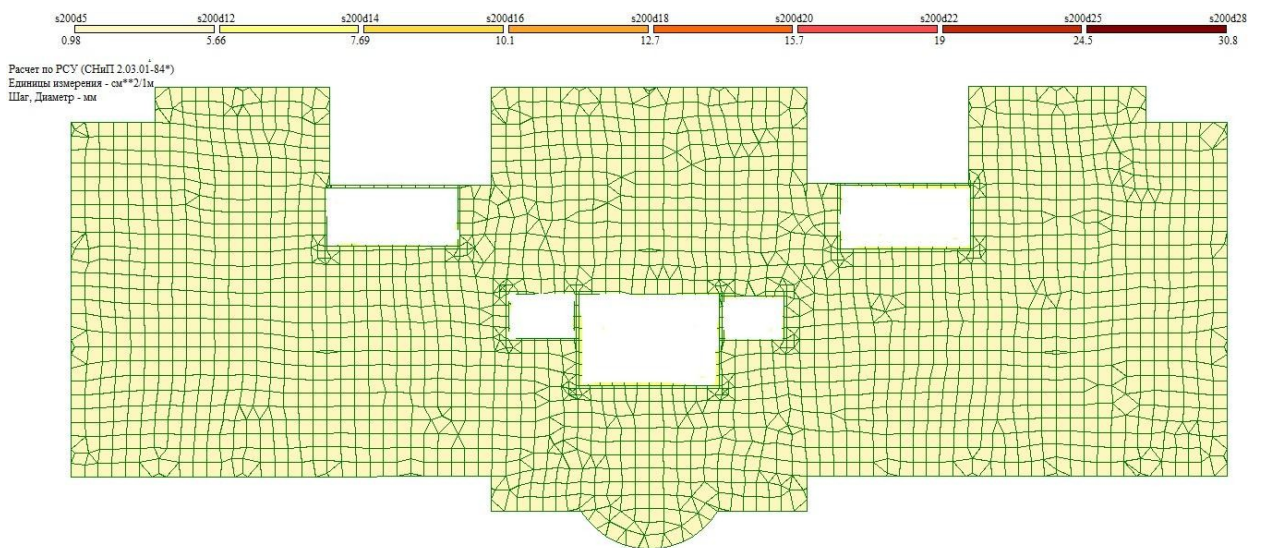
Армування плити за напрямком X. Верхня арматура
